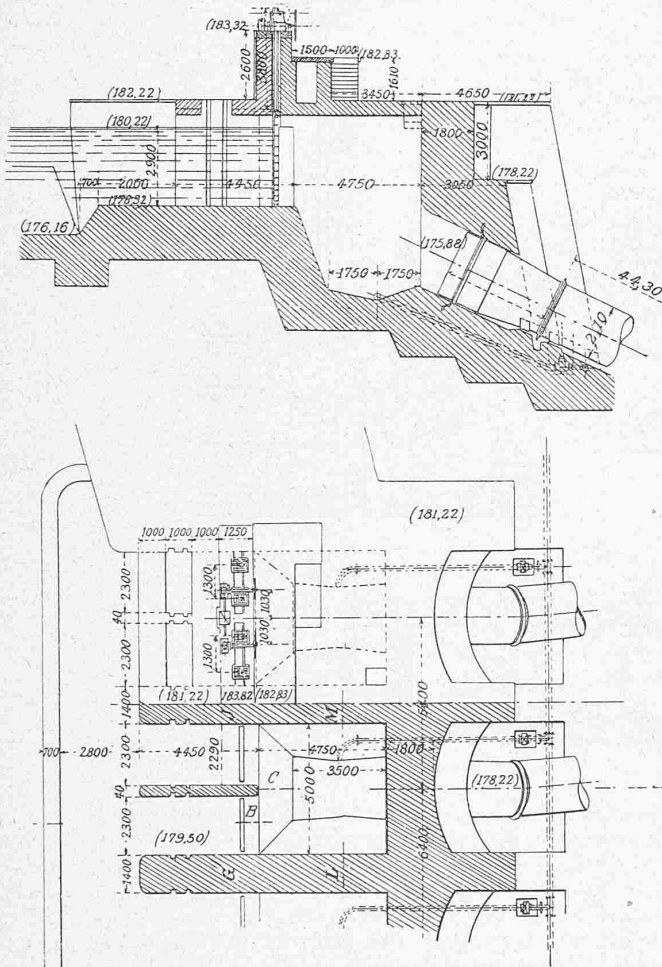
u. 8. Querschnitt und Grundriss des Wasserreservoirs J mit Rohrleitung. 1:250.
